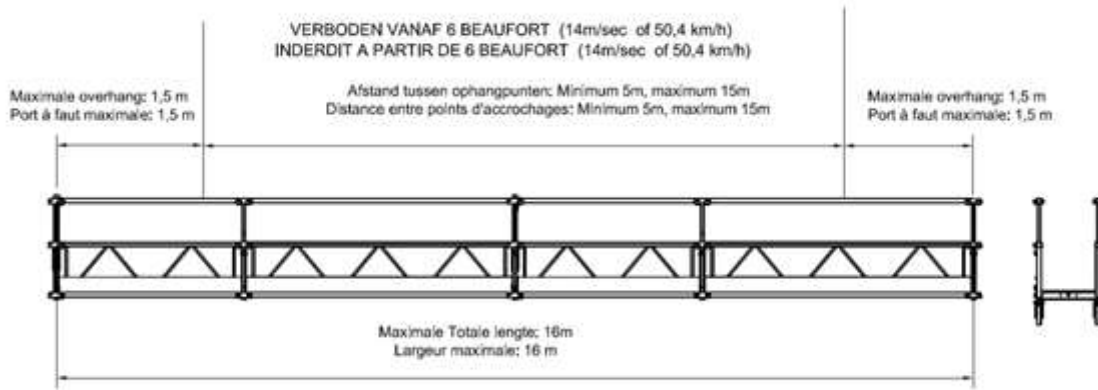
Inspectieplatform voor hoog landhoofd ingeval een flauw talud
